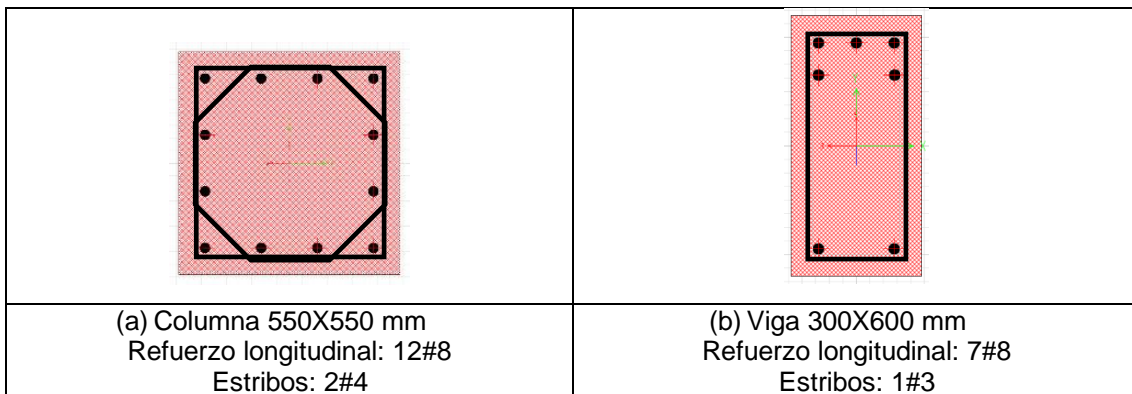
Edificio reducido con DFV: (a) Armadura típica en base de columnas, (b) Armadura en sección V7 en vigas
